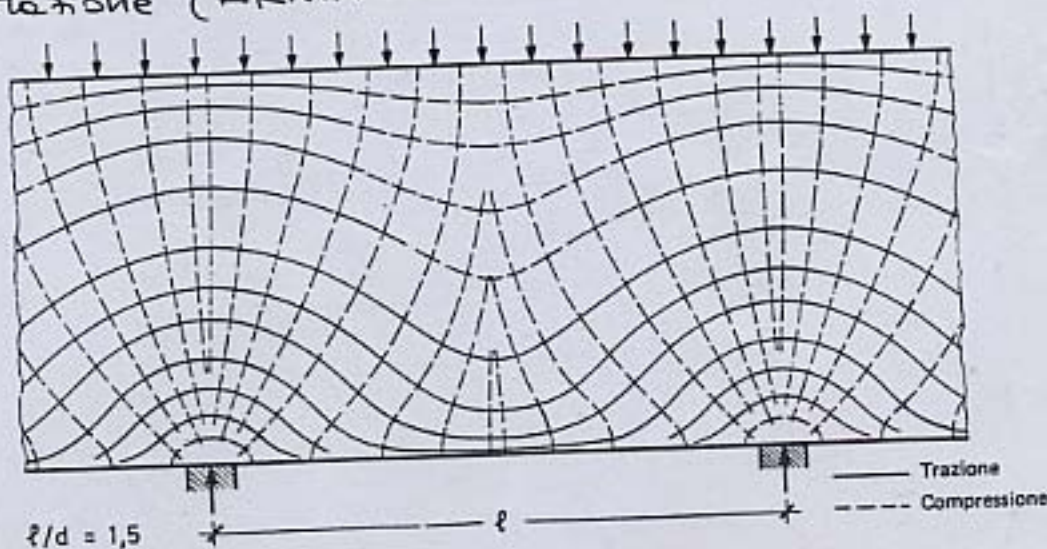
Andamento delle traiettorie delle tensioni principali nella trave-parete a più campi nello stato I con carico applicato dall'alto
